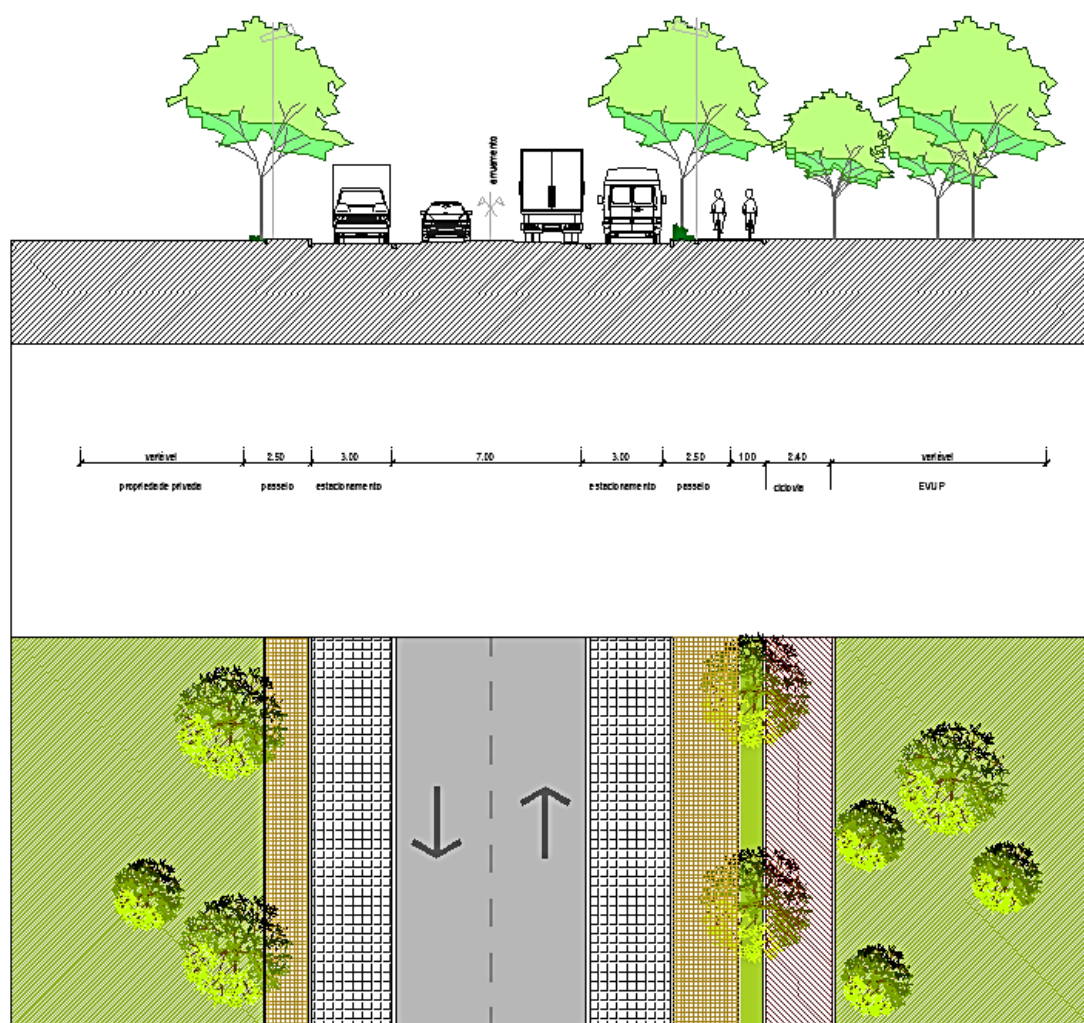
Solução urbanística da unidade de execução – Planta de Implantação
